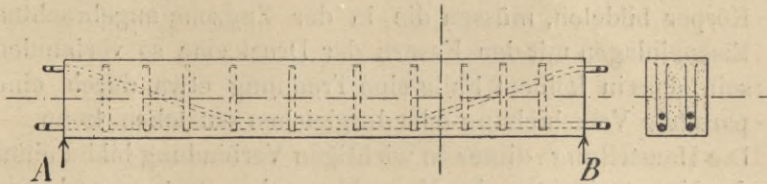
Armirter Betonbalken mit Bügel und gebogenen Eiseneinlagen.
